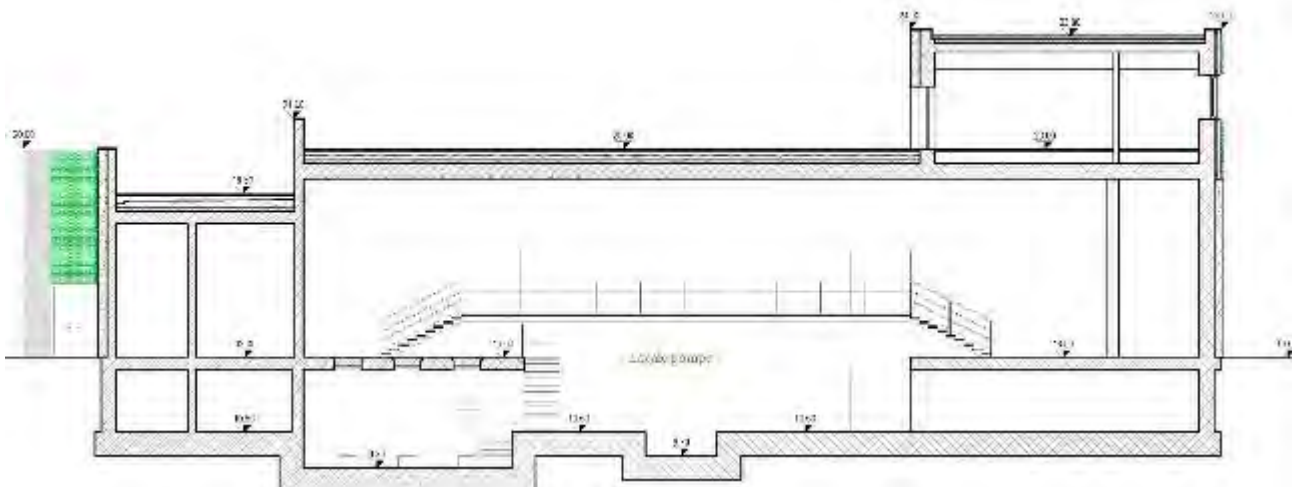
Estratto della Sezione con il locale pompe (estratto dal Progetto Definitivo).
